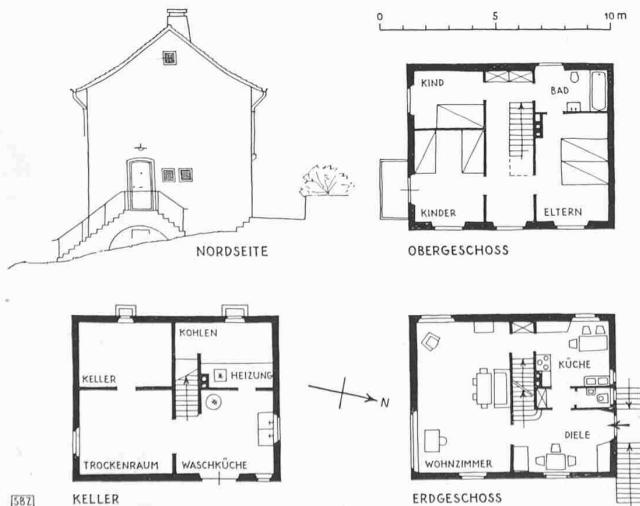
Grundrisse Haus «A», Maßstab 1:300
